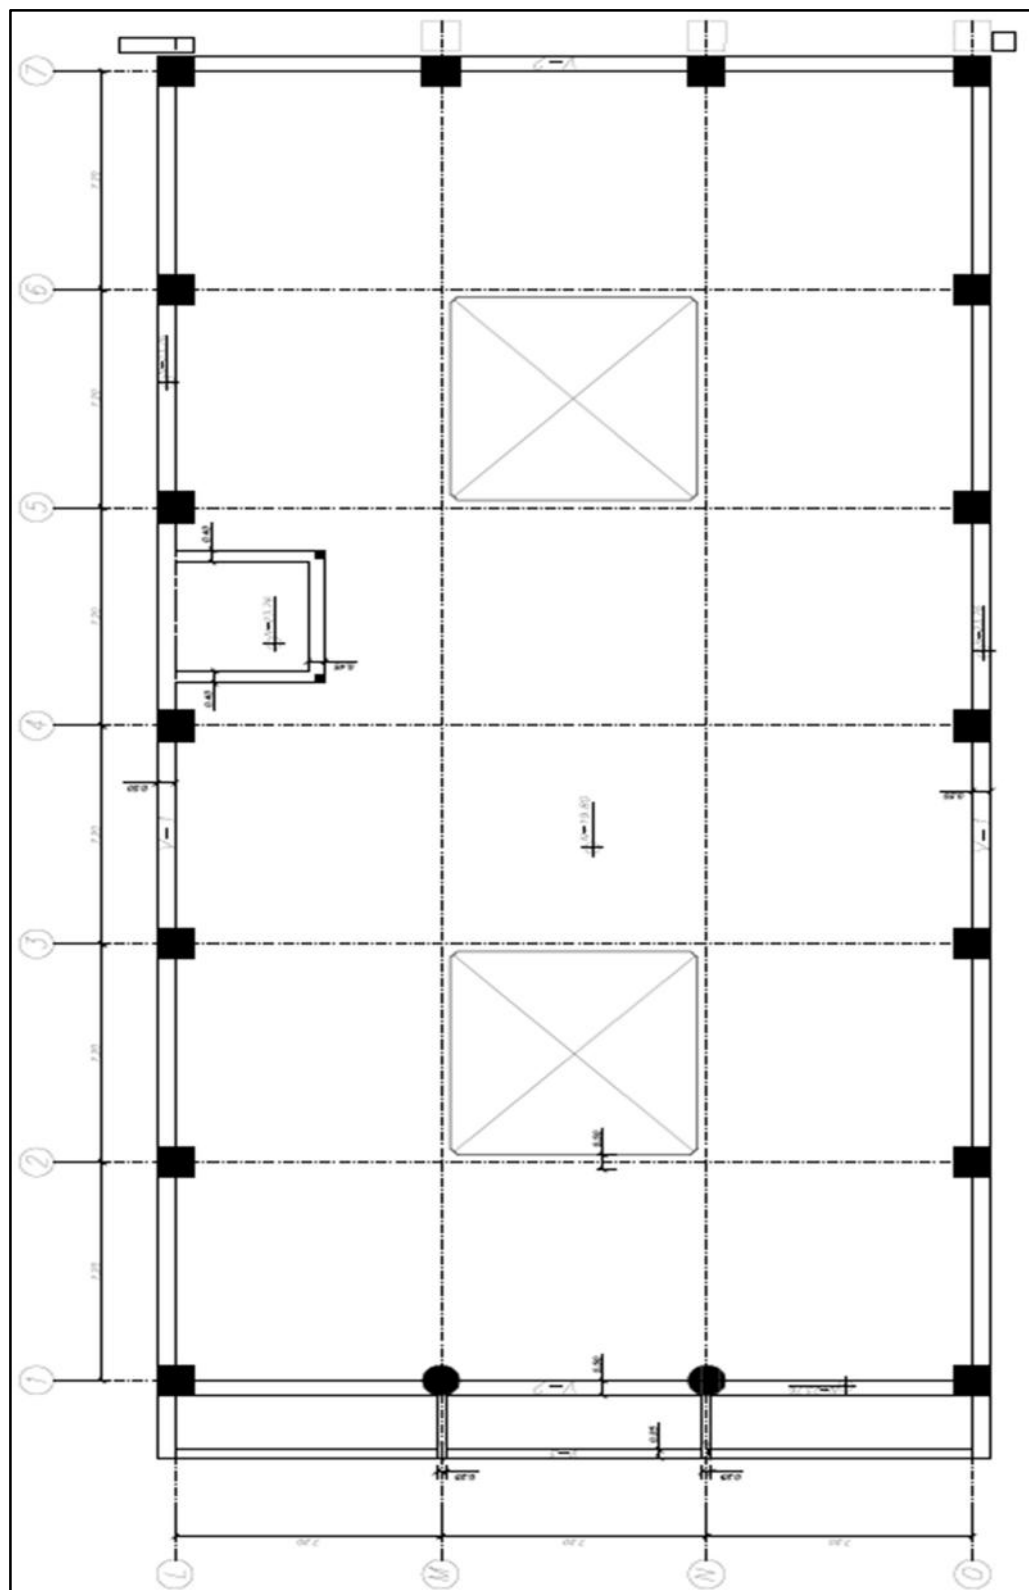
Planta estructural N+23.76m, Gobernantes
